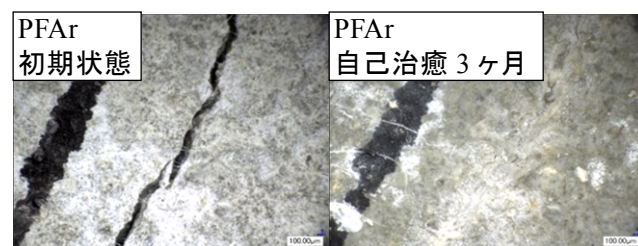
ひび割れを導入した補修材の自己治癒状況
